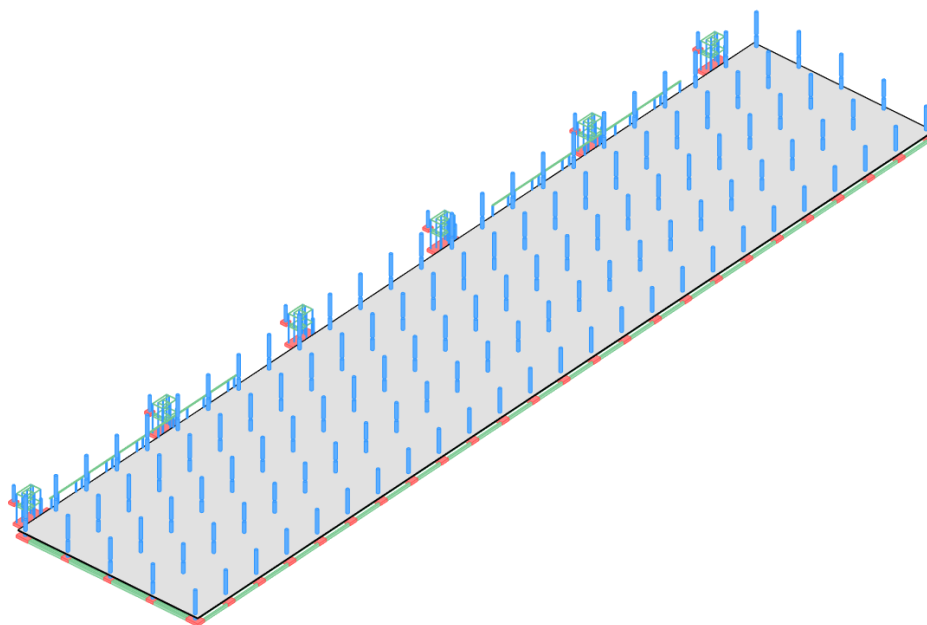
Vista 3D de la solera de la planta baja junto al resto de la estructura.
